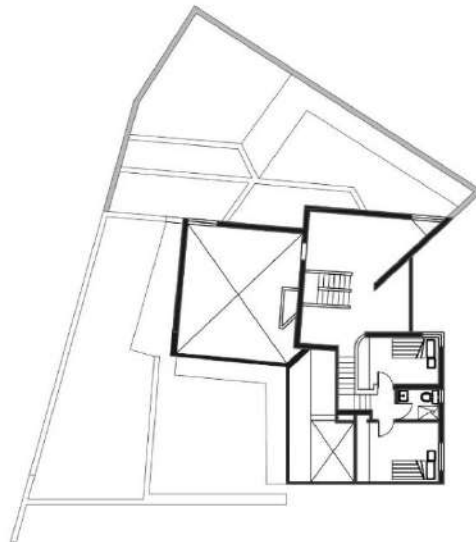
Planimetría Casa Amaral, primera planta. Tomado de: Mejía, C. Torres, J. (2014). Edición: La Autora (2021).
